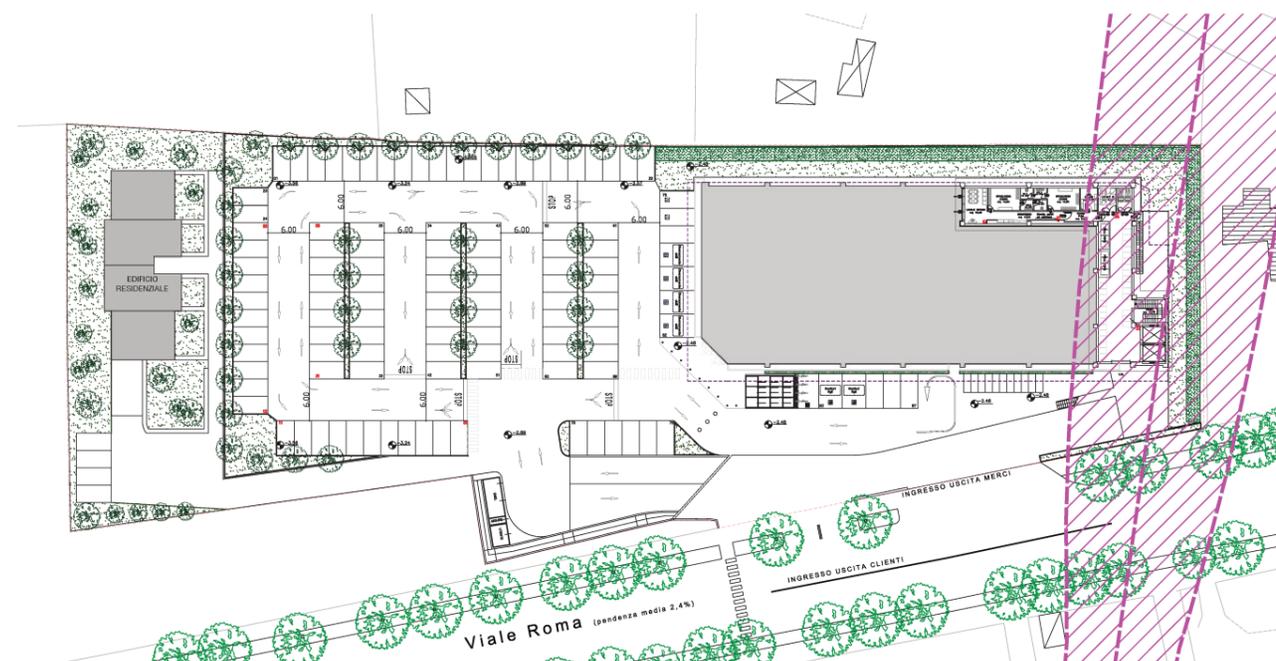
Planimetria Piano Primo con individuazione della fascia di rispetto dell'elettrodotto
